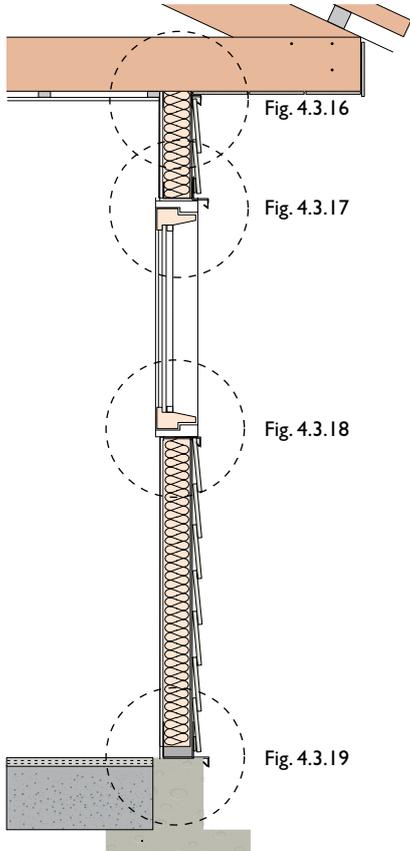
Encuentro aleros exteriores fachada en Superboard Siding® con estructura metálica
